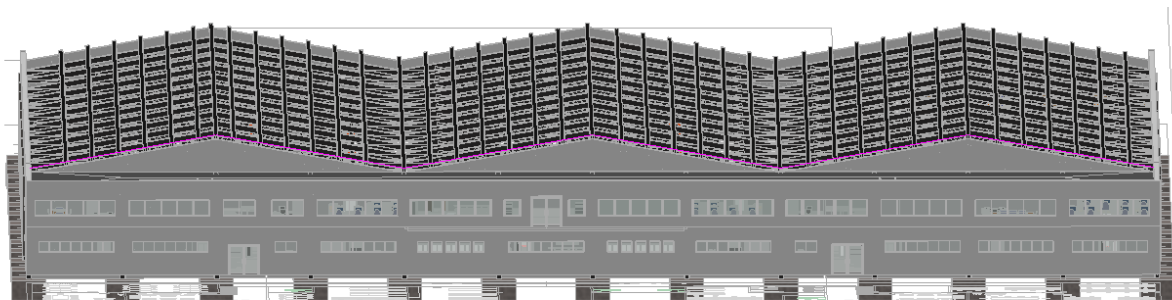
Estructura muro de hormigón enlucido Fuente: Elaboración propia
